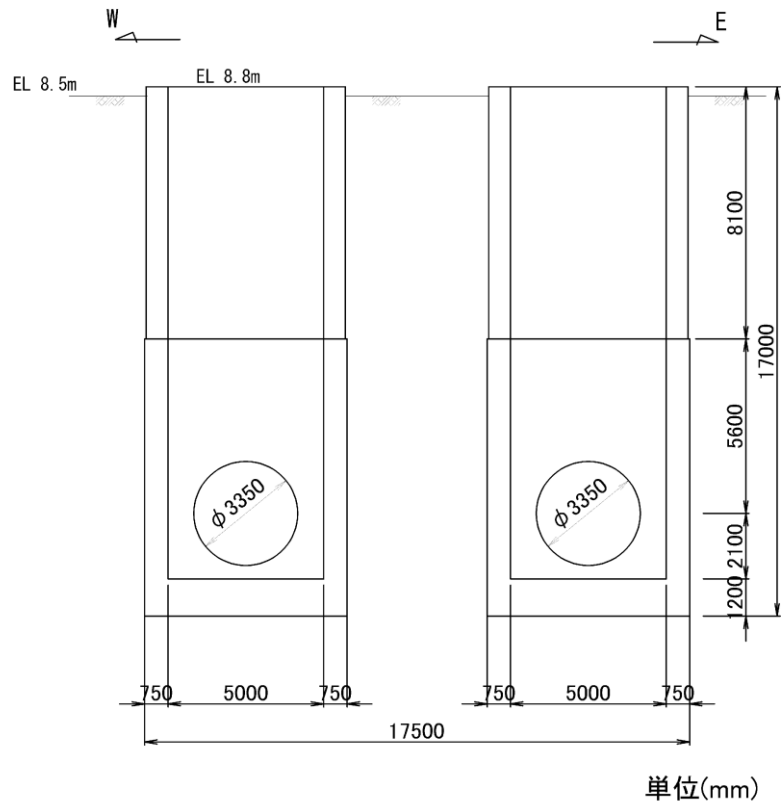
1号機取水槽 断面图(B-B断面)
